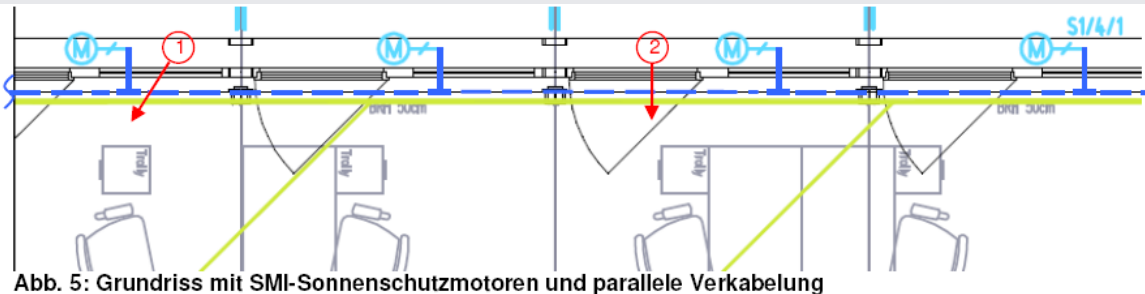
Grundriss mit SMI-Sonnenschutzmotoren und parallele Verkabelung
